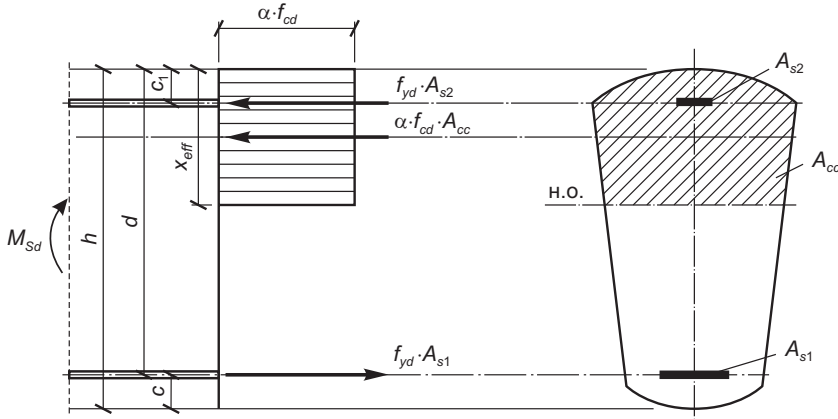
Схема усилий и эпюра напряжений в сечении, нормальном к продольной оси изгибаемого железобетонного элемента, при расчете по прочности
